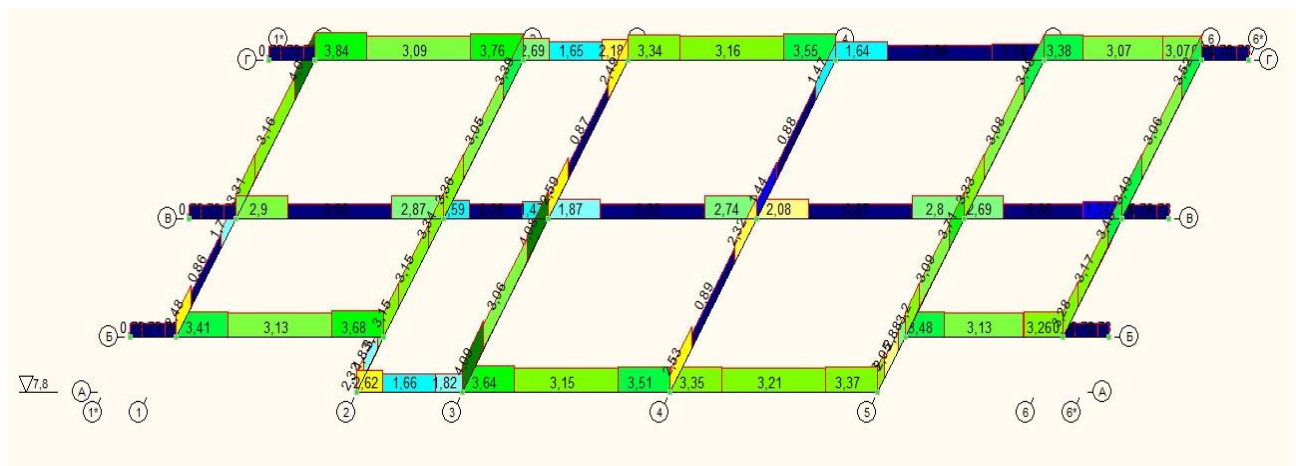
23 – Сумарна площа поперечної арматури, см
